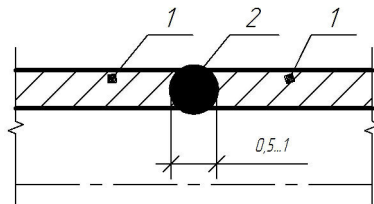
Контактне стикове зварювання поліетиленових труб: 1-з'єднувальні кінцівки труб, 2- зварний шов.
